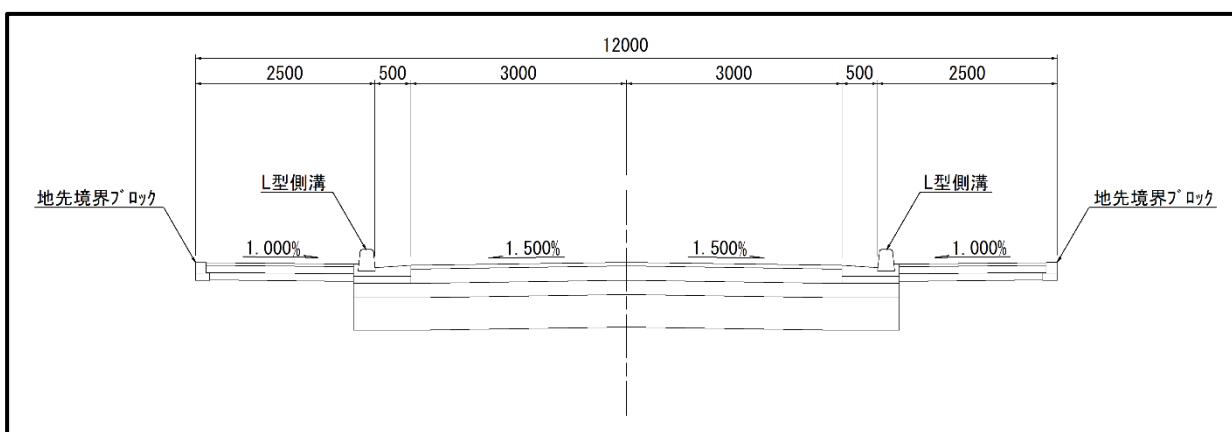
(3) 道路の標準断面図（補助幹線道路 12-1 号線 幅員 12.0m）
